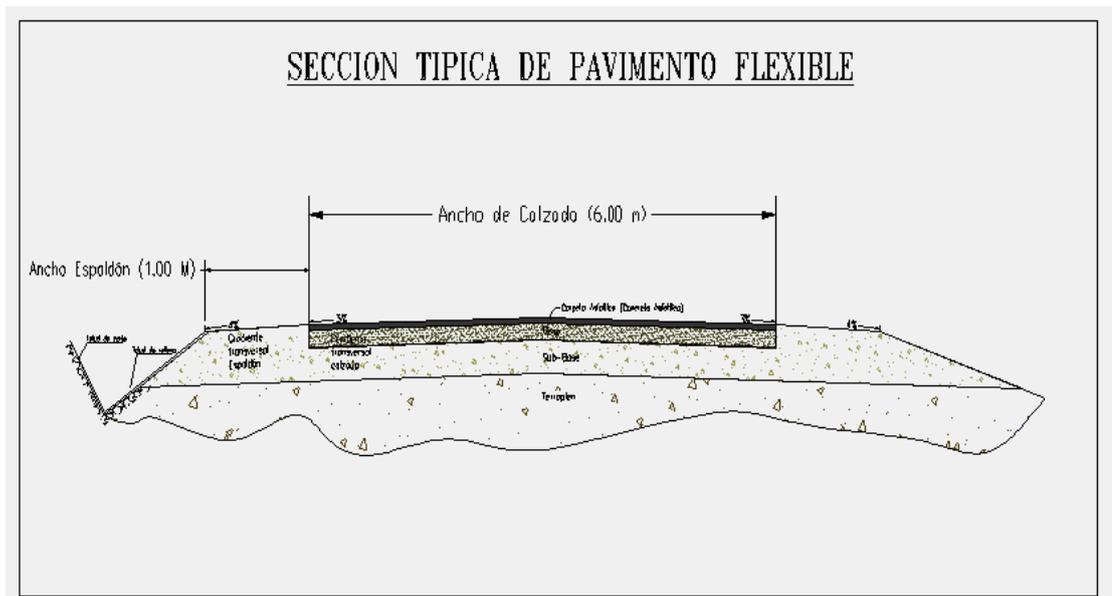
Sección Típica de Pavimento Flexible
